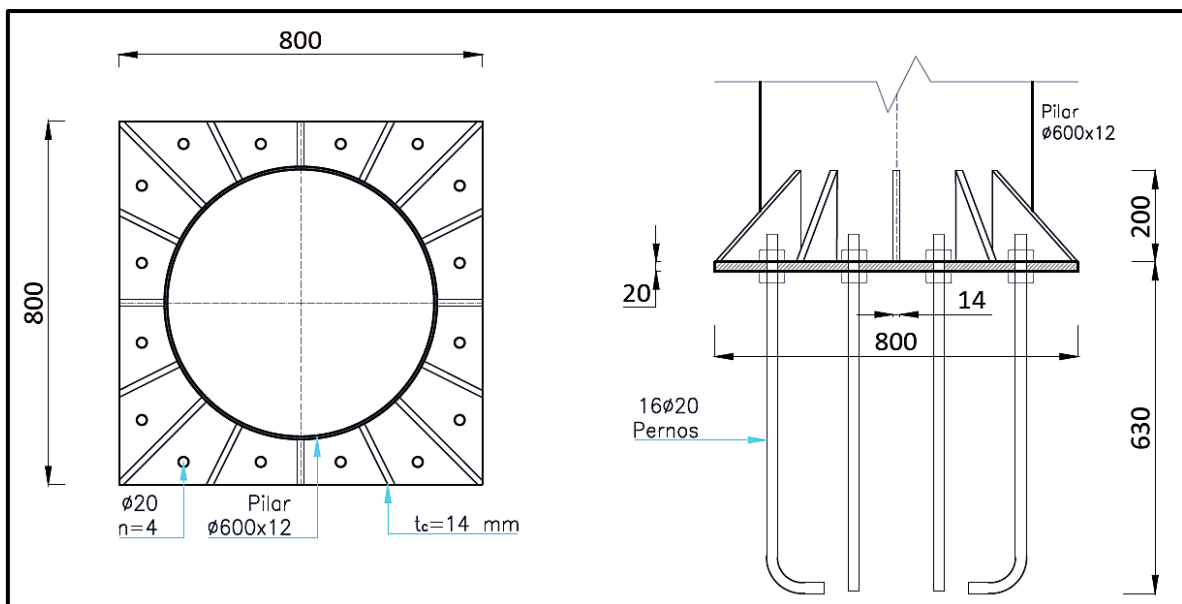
Dimensiones de la placa de anclaje para pilar Ø600x12.
